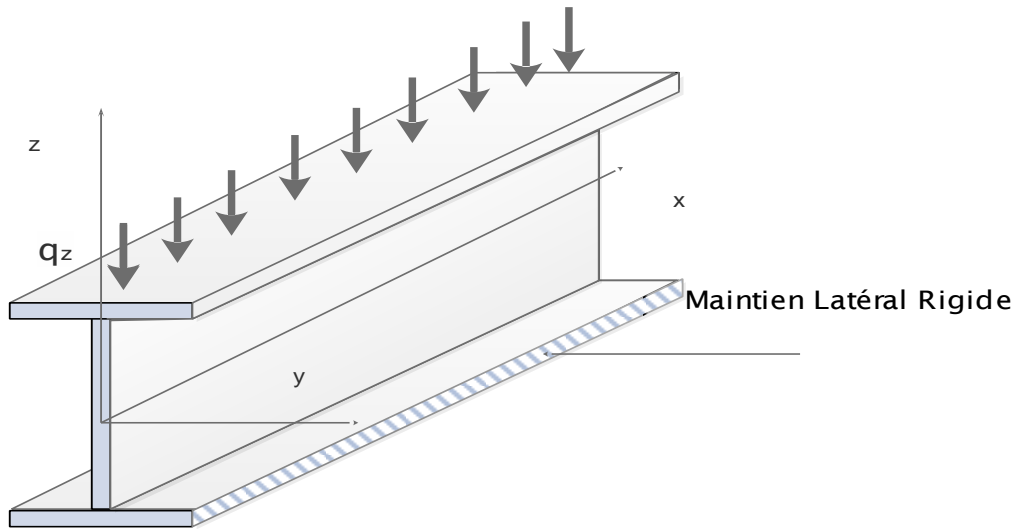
Poutre en I maintenue latéralement au niveau de la semelle tendue
